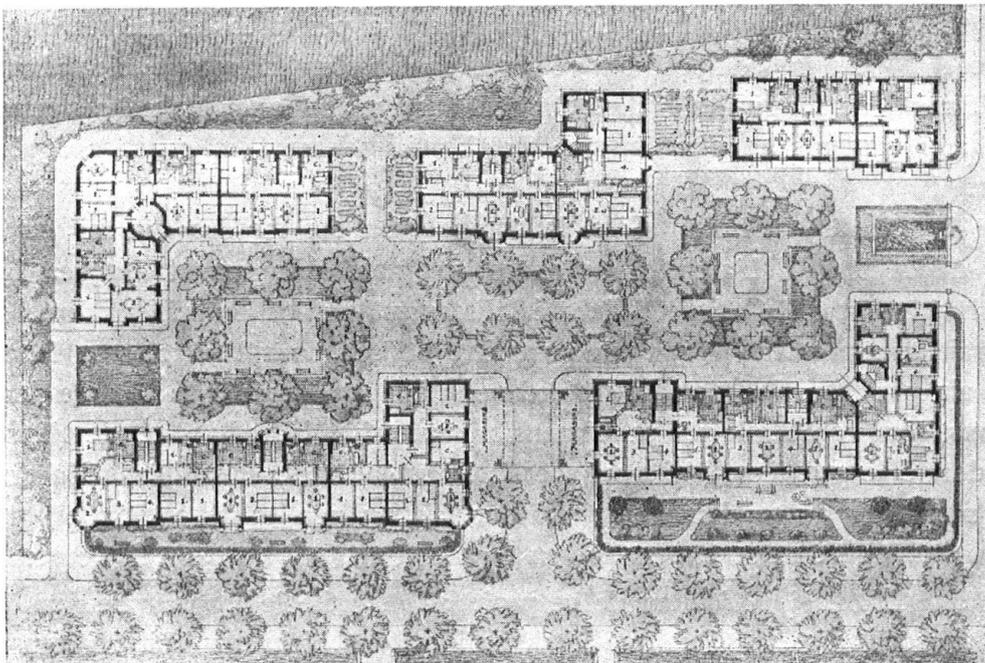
Projet „Sol“. Plan. — *Abb. 3.* Entwurf „Sol“. Plan.
